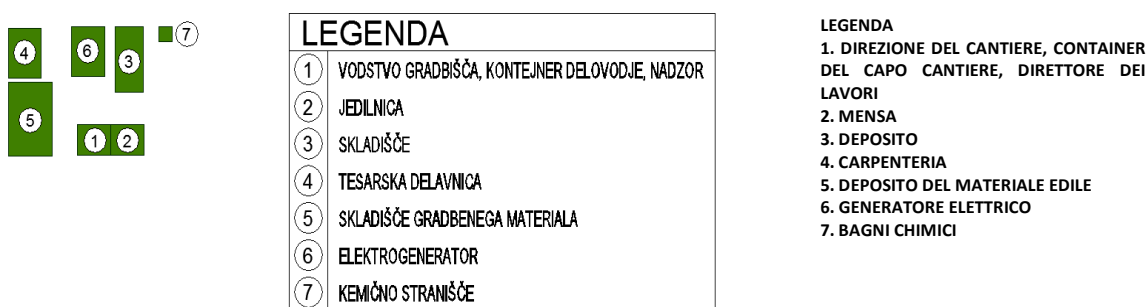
Cantiere tipo GR-A (per strutture piccole, strade etc.)
